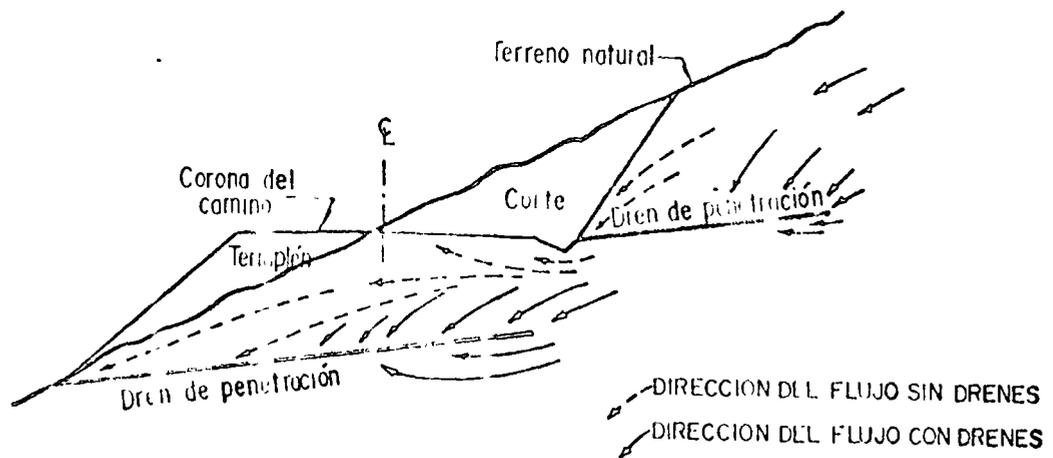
Esquema de la influencia de los drenes transversales de penetración en un corte en balcón.
